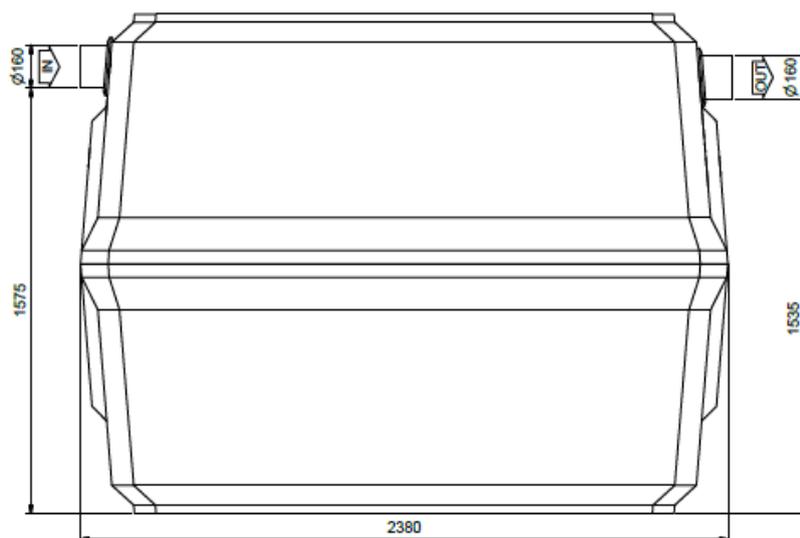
Plan d'encombrement d'un Hydrosep® C-90 3l/s
